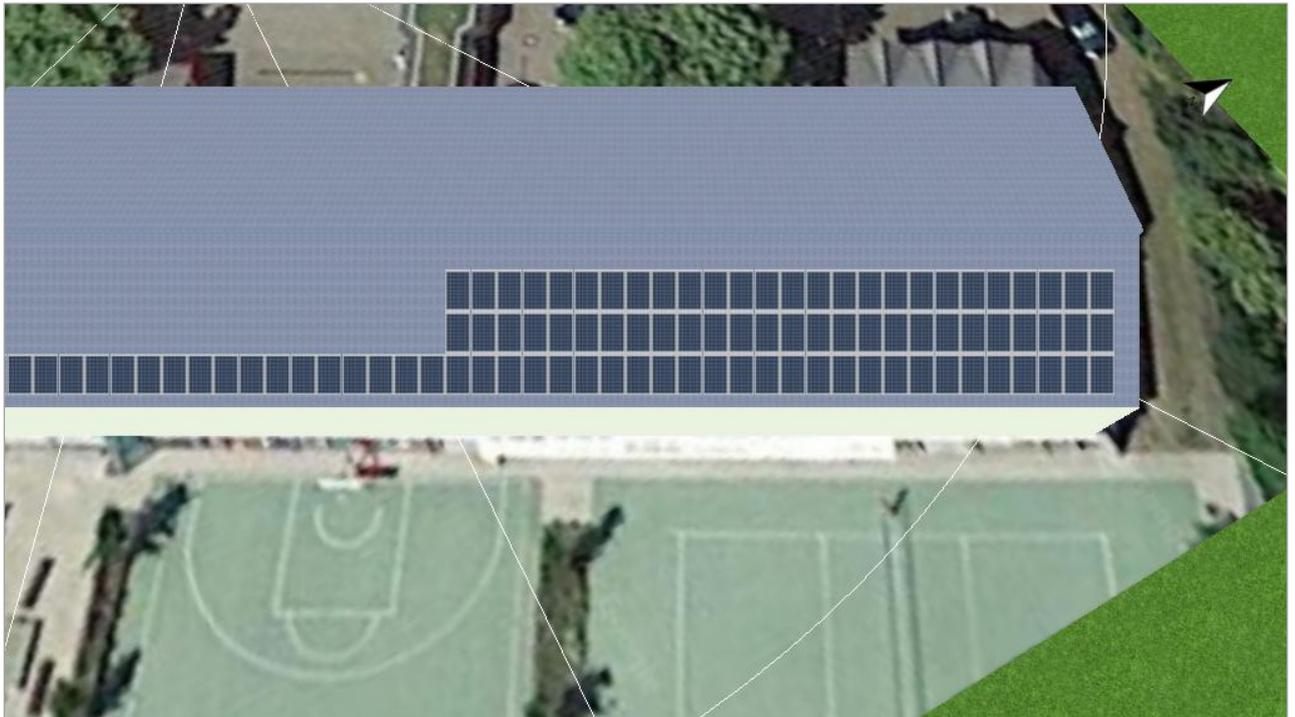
Modulfläche - Gebäude 07-Dachfläche Südost
